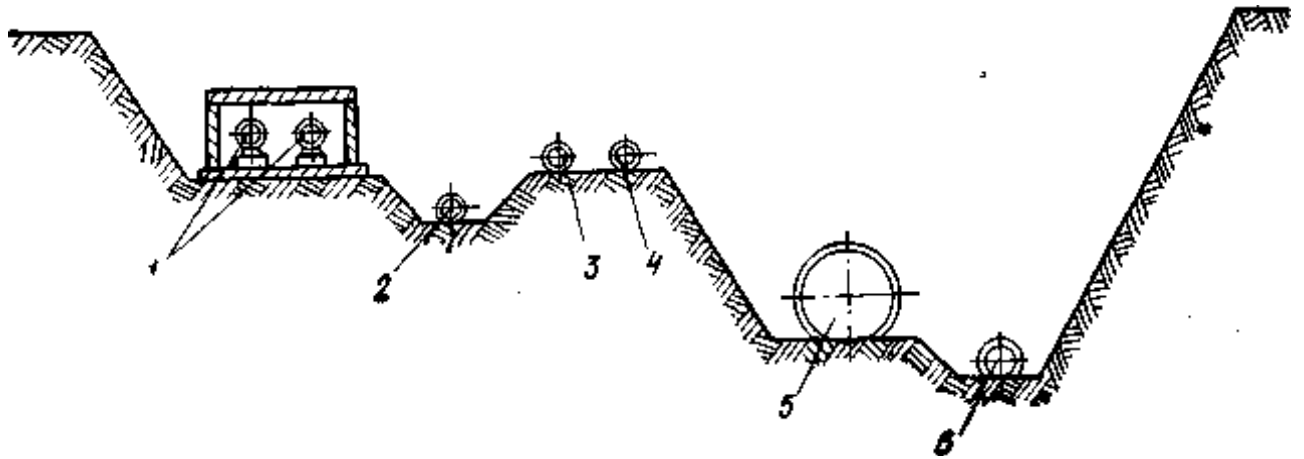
Укладка подземных сетей в открытых выемках при одностороннем размещении: 1 - теплосеть; 2 - водопровод; 3 - газопровод среднего давления; 4 - газопровод низкого давления; 5 - водосток; 6 – водоотводящая сеть
